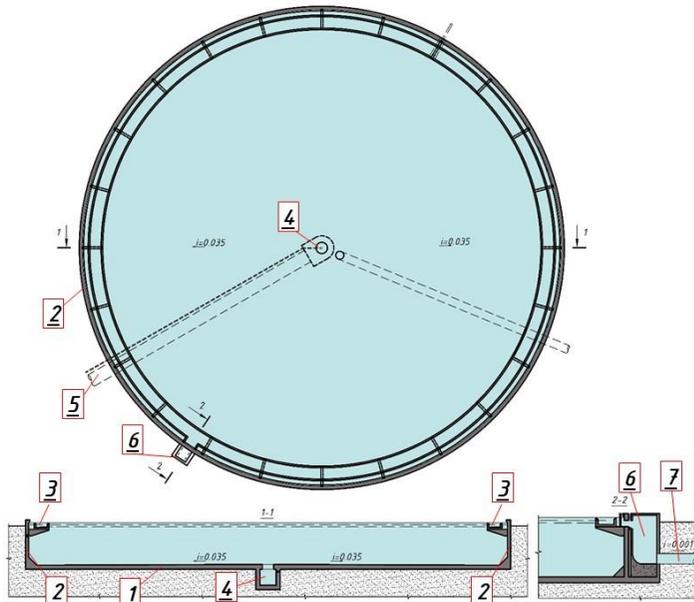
Радіальний відстійник із монолітного залізобетону:
